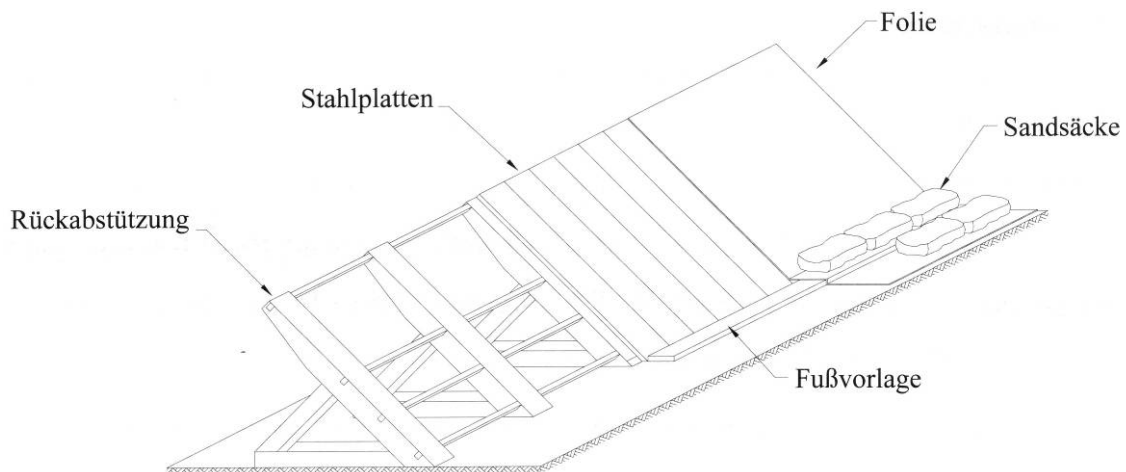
Aufbau einer Stellwand mit metallischen Wandelementen [142]
